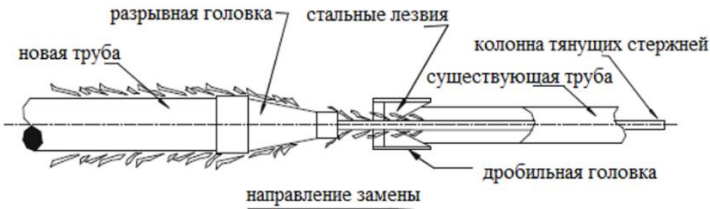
Общий вид дробящей головки (система IMPIPE)
